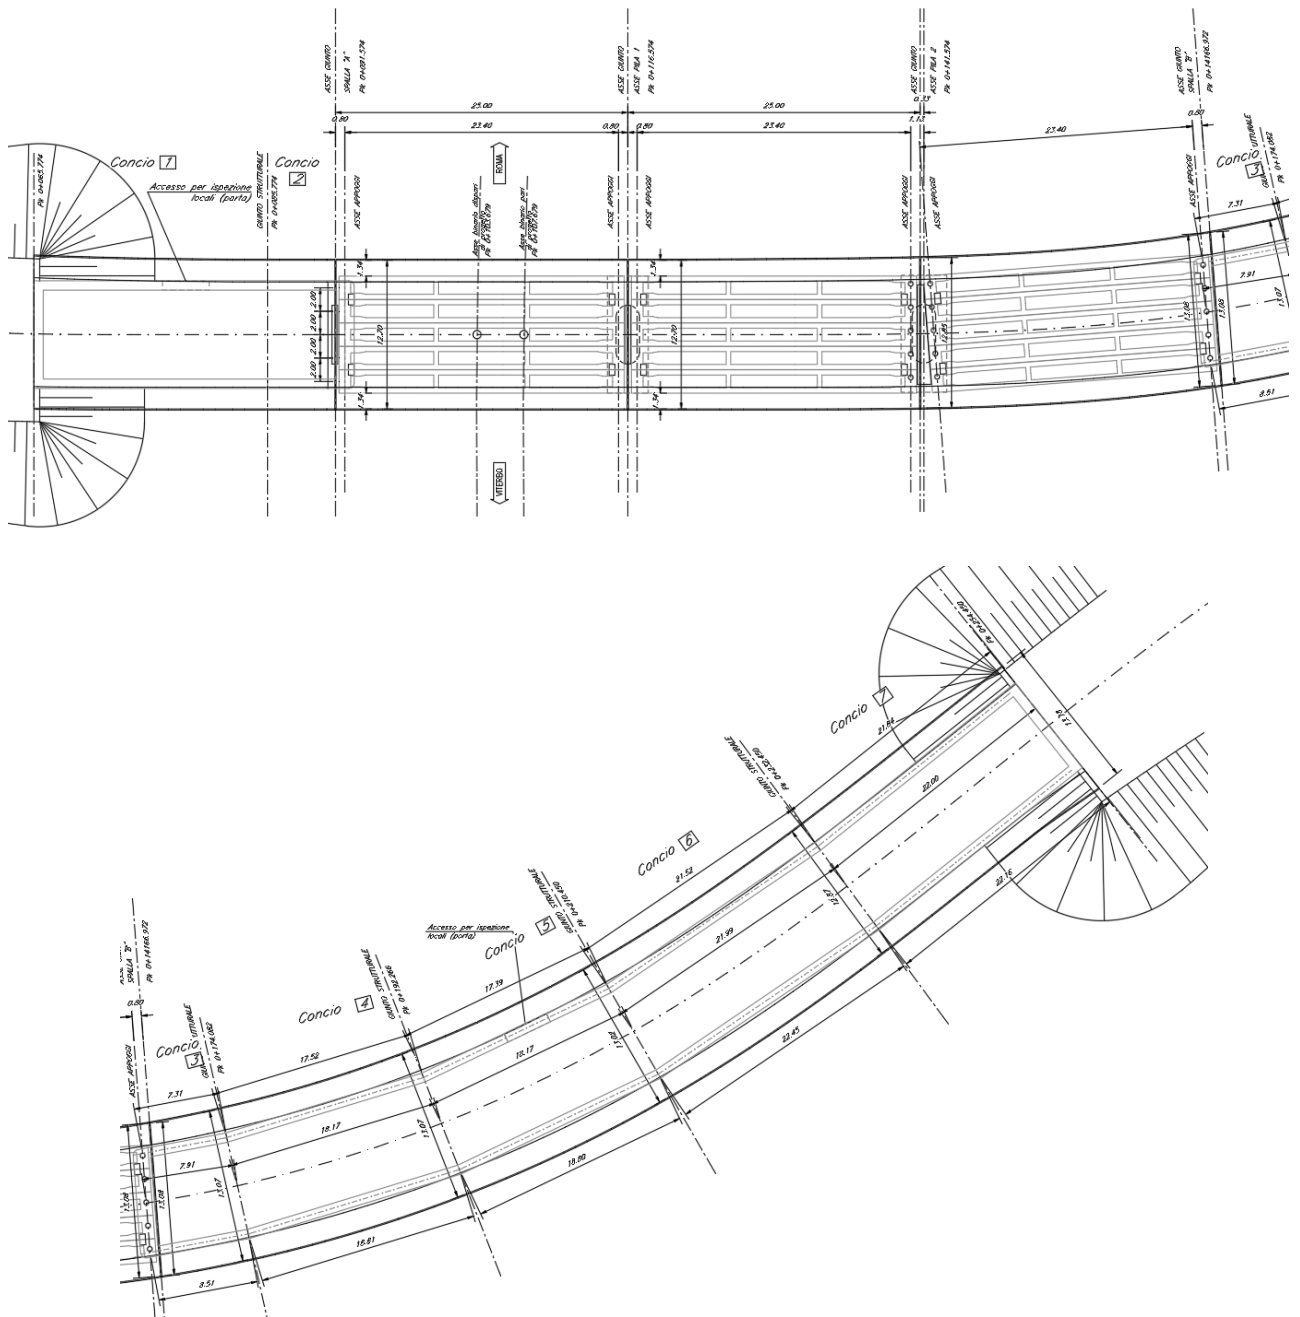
Planimetria generale con ubicazione dei conchi che costituiscono le rampe di accesso
